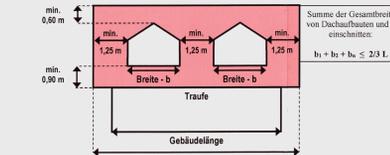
Abmessungen zulässiger Dachaufbauten (hier Beispiel: Sattellaube)
